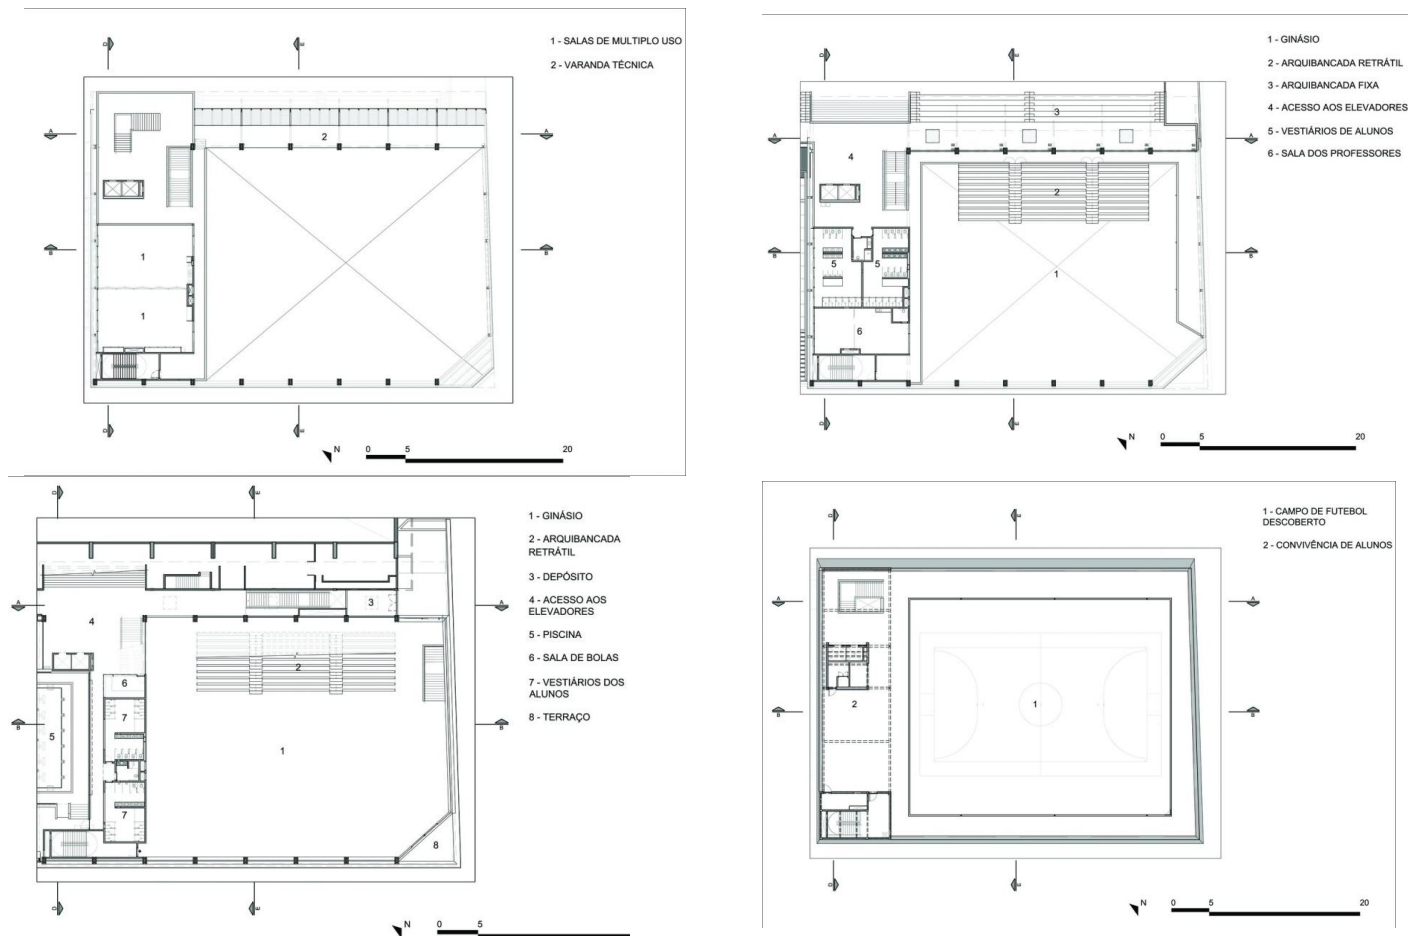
Plataforma Arquitectura. Planimetria Centro Deportivo San Luis..
